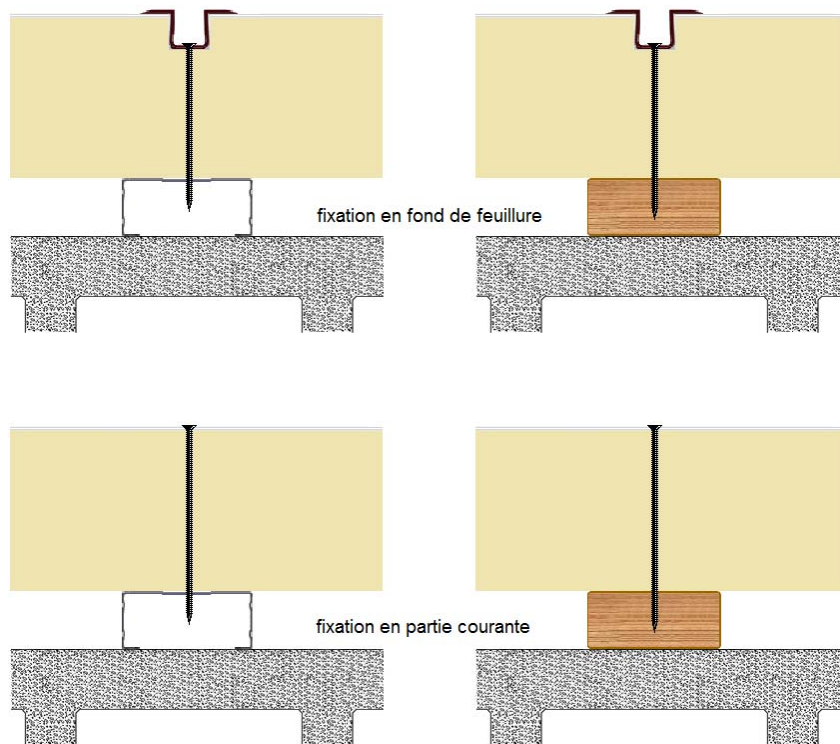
Fixation des panneaux EFICHOC PLAFOND et EFICHOC PAROI dans l'ossature
